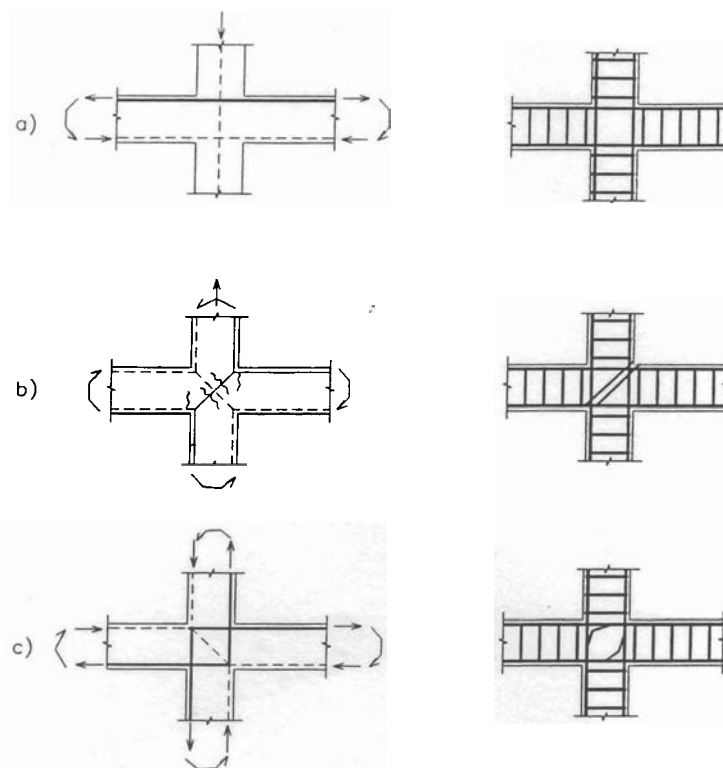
Arranjo de armadura para ligação viga intermediária - pilar intermediário
